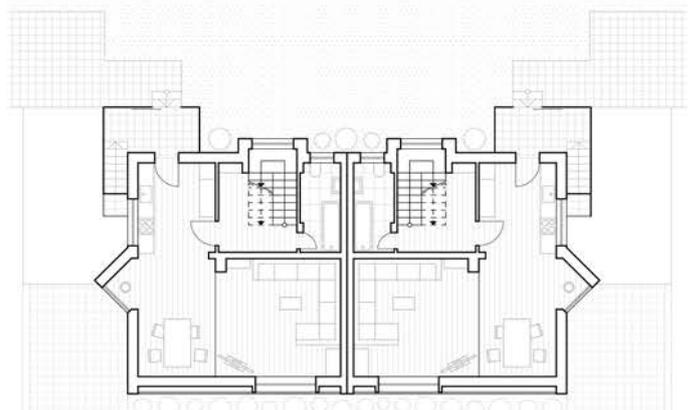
Grundriss Erdgeschoss M 1:200
